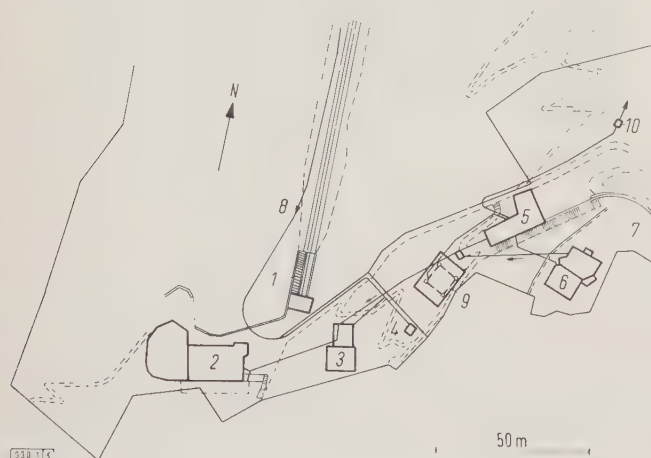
Lageplan der Gebäude, Türme und Verbindungswege auf dem Monte San Salvatore.
